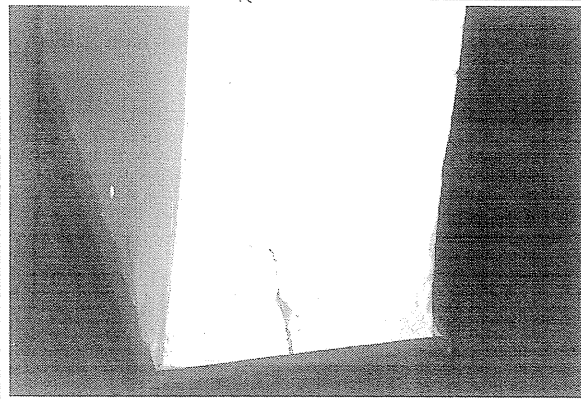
Fisuras en la base de los muros del costado occidental.
